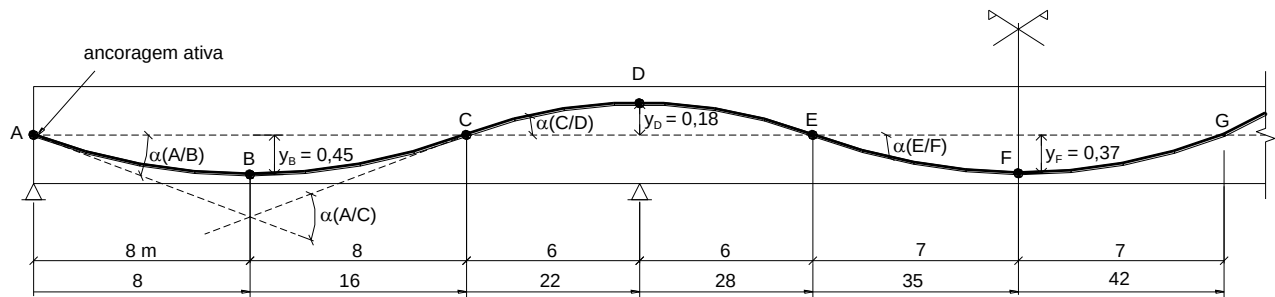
Posicionamento da armadura de protensão ao longo da viga na viga pós-tensionada.
